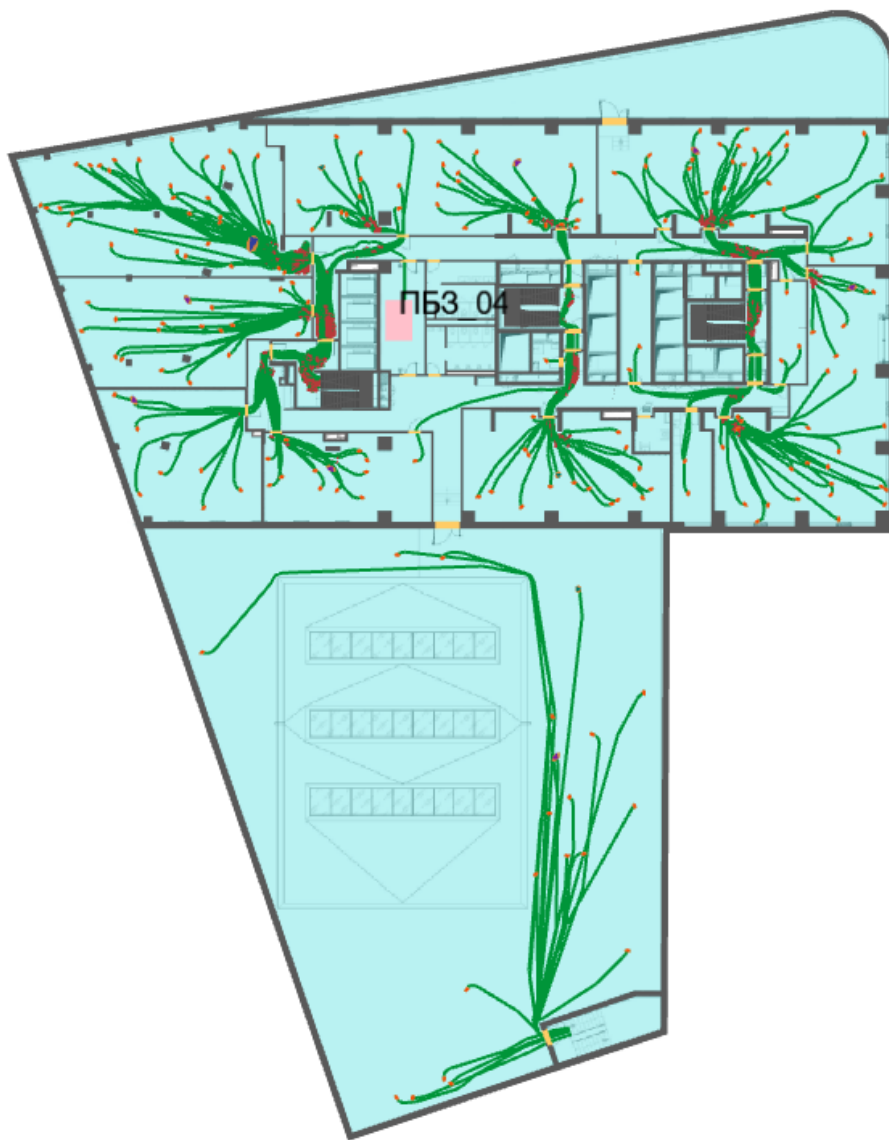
План 2-го этажа и нанесенная на него расчетная (принципиальная) схема эвакуации
